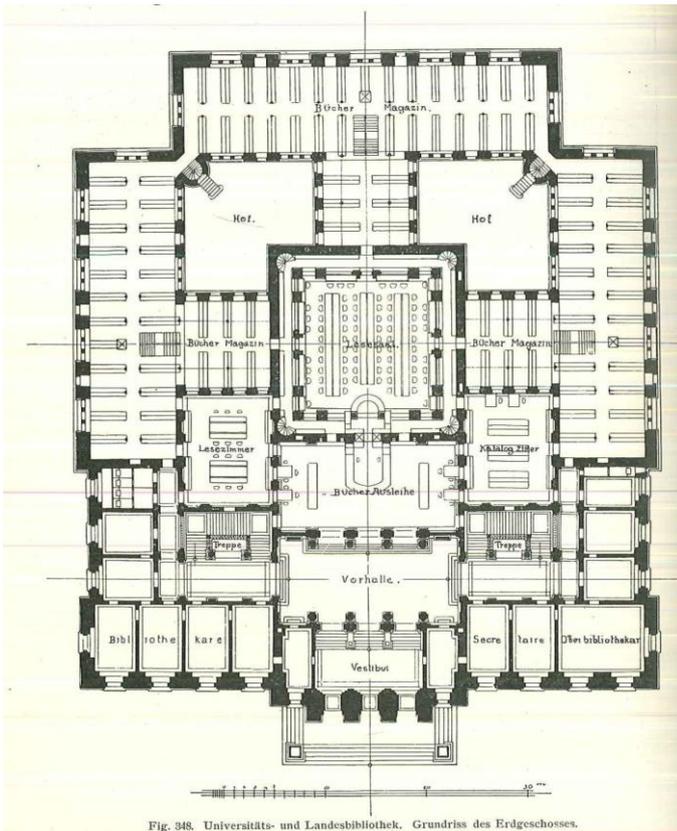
Universitäts- und Landesbibliothek. Grundriss des Erdgeschosses.
